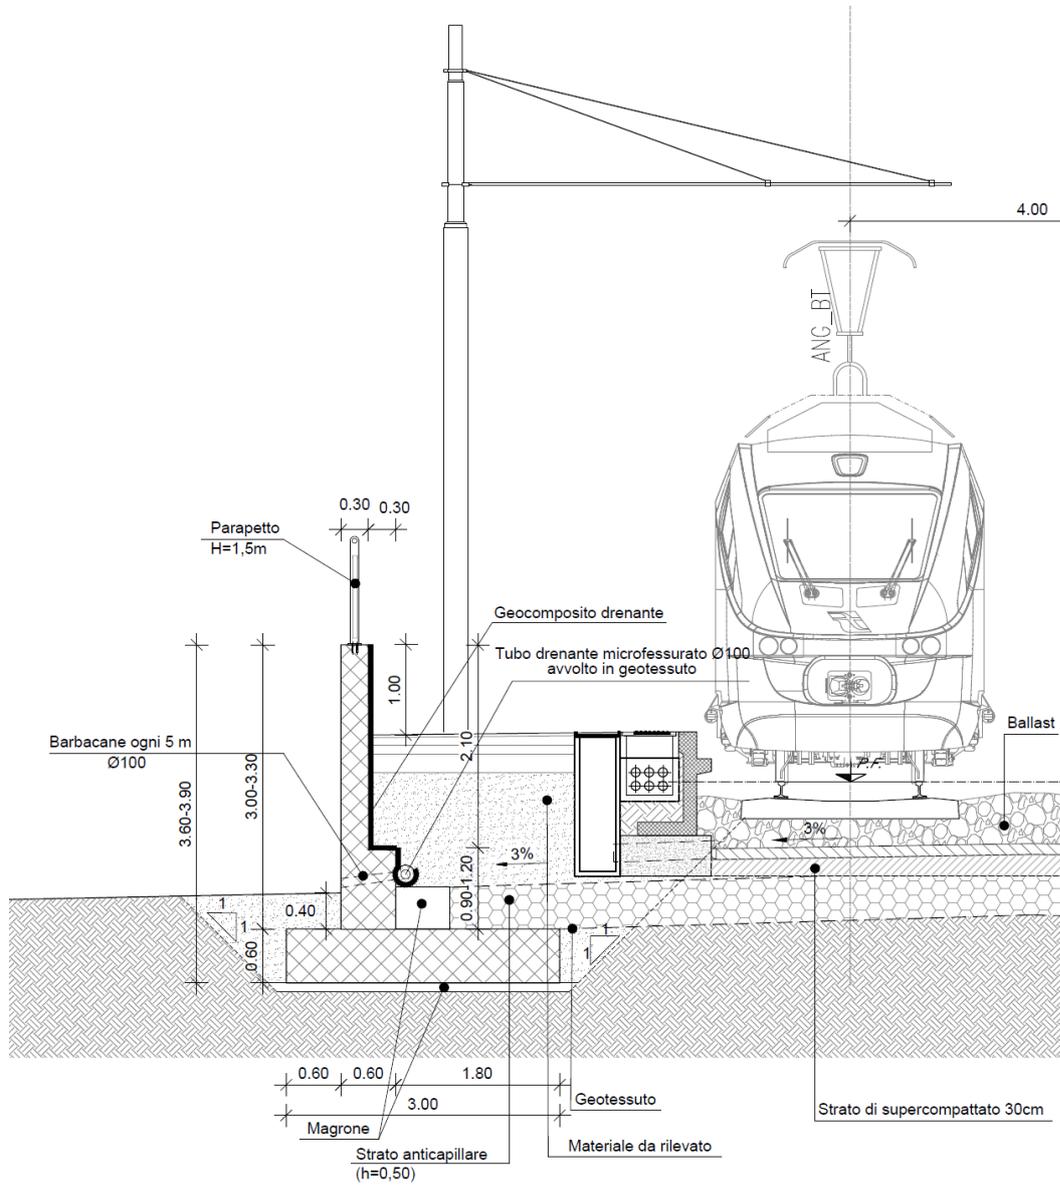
Muro Tipo A – Sezione trasversale tipo H390 cm
